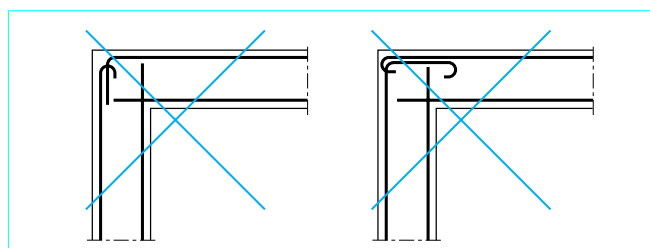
Dispositions à éviter dans les portiques très sollicités (risques de désordre dans l'angle extérieur)
